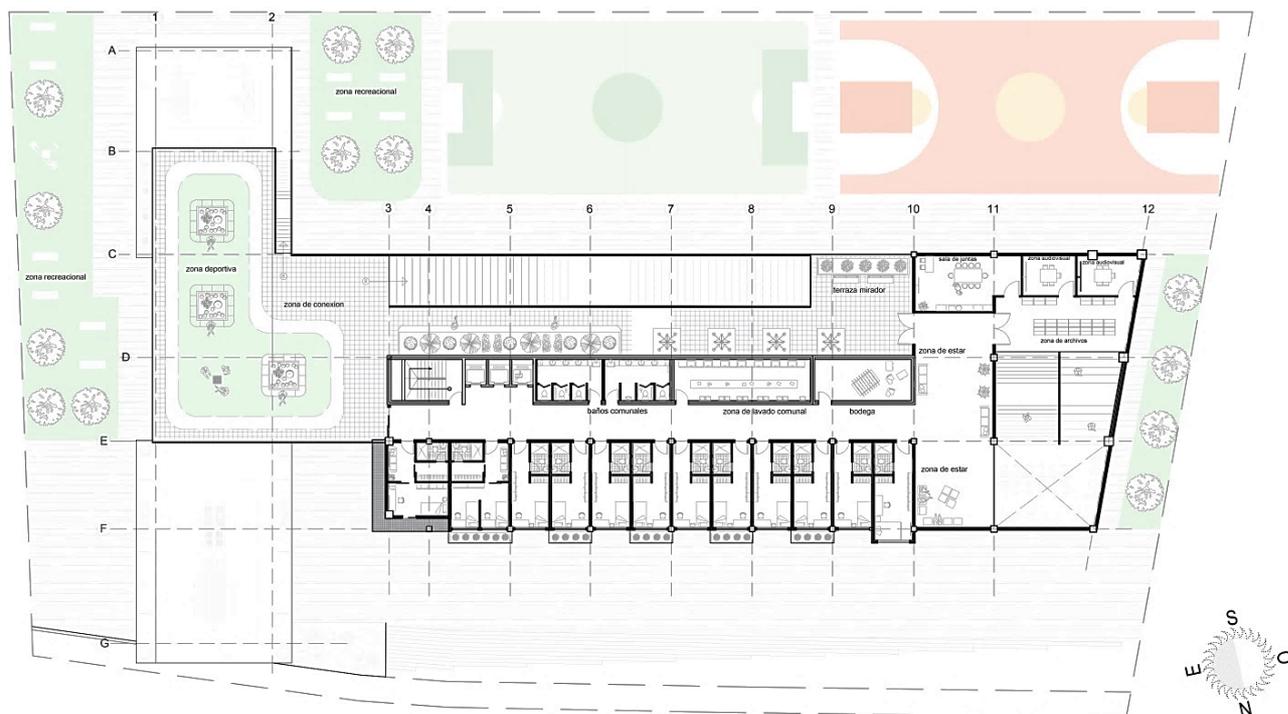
Planta: piso 6 Cevallos. (2018). Creación propia
